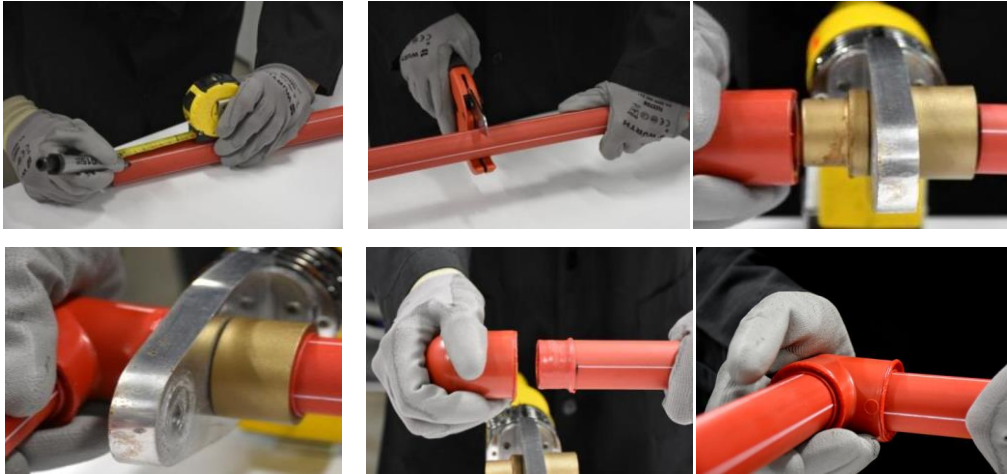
Termofusión: soldadura a tope. Proceso
